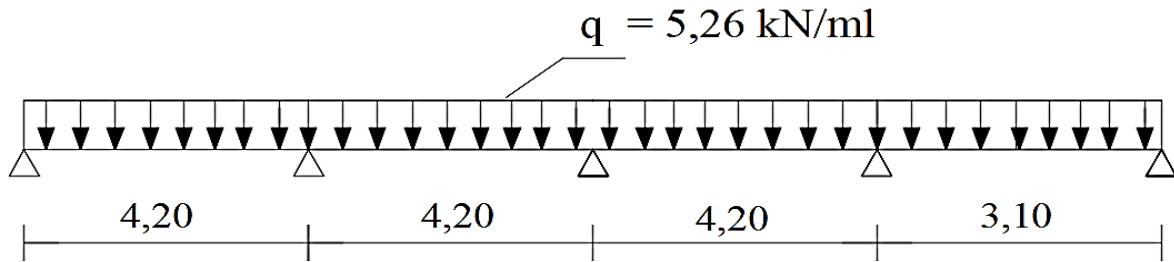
Schéma statique de la poutre continue reposant sur 6 appuis
